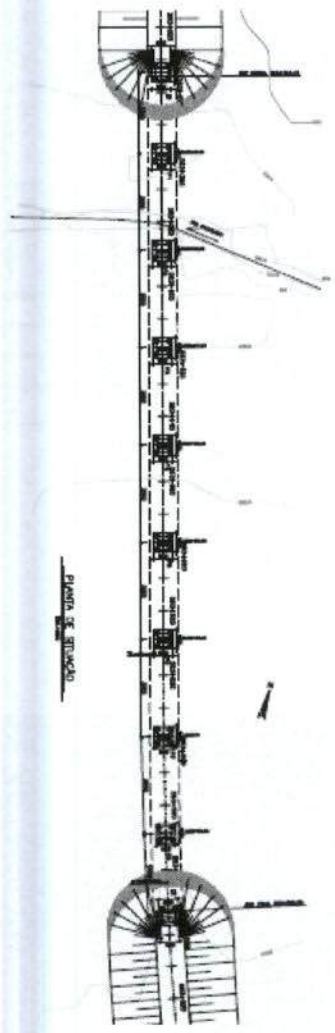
Projeto da ponte sobre o Rio Cacheado (planta de situação)
